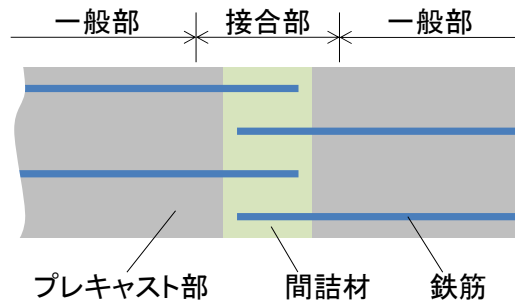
鉄筋の千鳥配置がある場合における供試体の接合部のイメージ（平面図）
